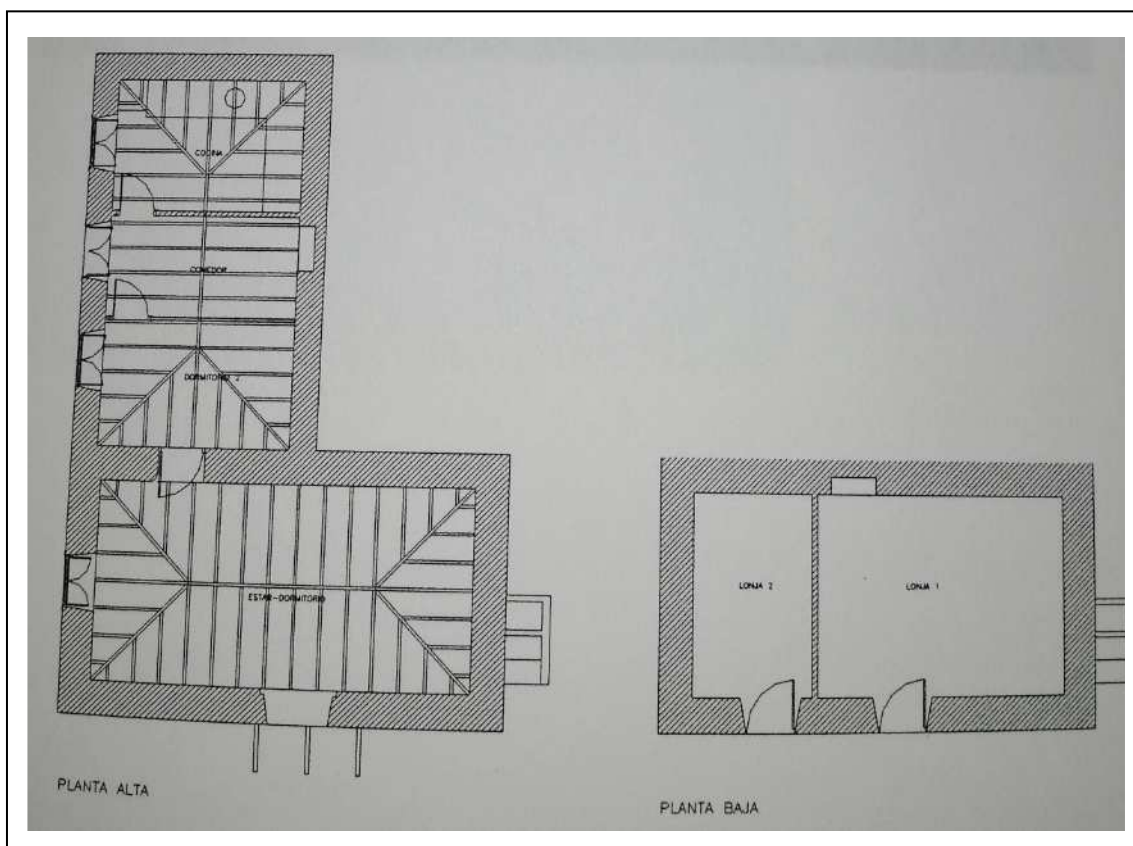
Elaboración propia. Planta tras la reforma. Casa las Embelgas.
